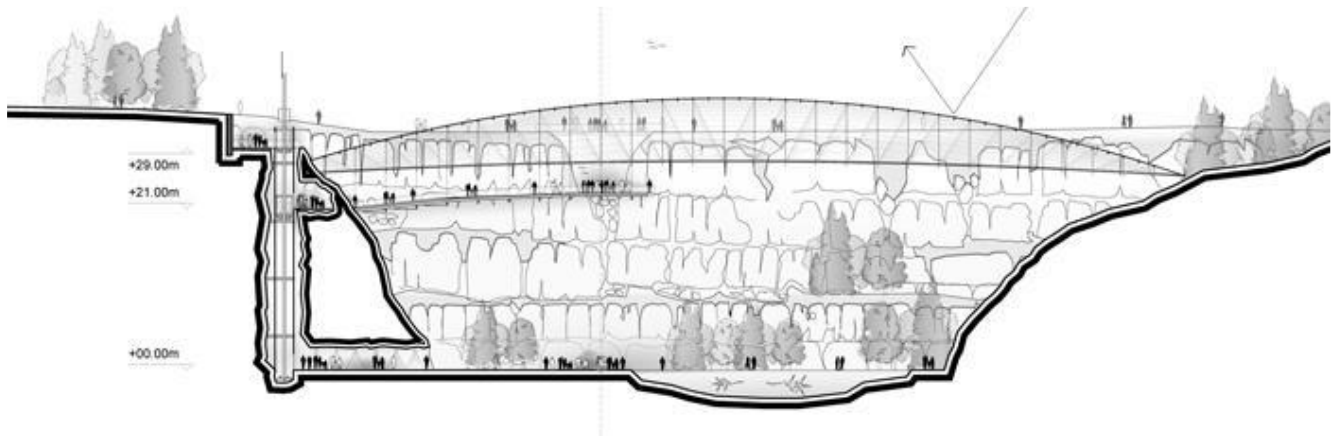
Проект будівлі музею у Портленді. Архітектурне бюро Renzo Piano Building Workshop
